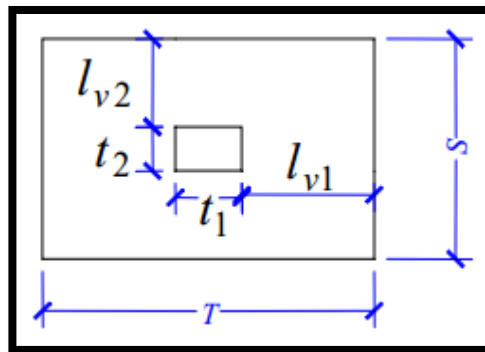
Dimensiones en planta para calcular en una zapata aislada. Fuente: Roberto Morales (2005).
